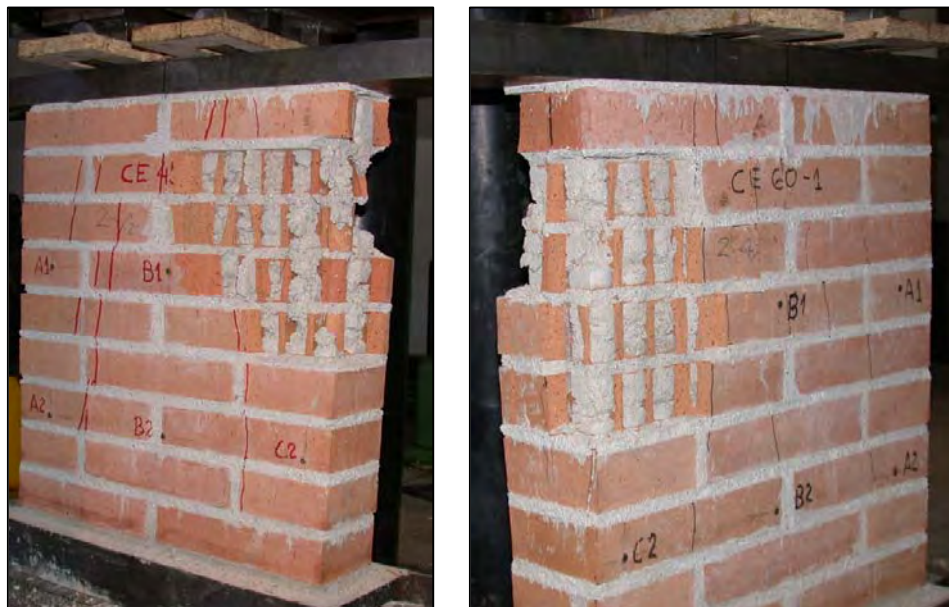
Rotura de los muretes de excentricidad baja CE45-3 y CE60-1. En ambos casos se observa el fallo por aplastamiento localizado en la cara de compresión y la fisuración vertical
